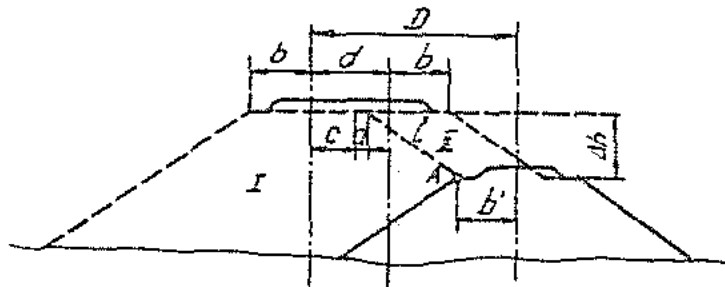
Dublarea liniei în rambleu cu rectificarea axei liniei existente în plan și în profil
